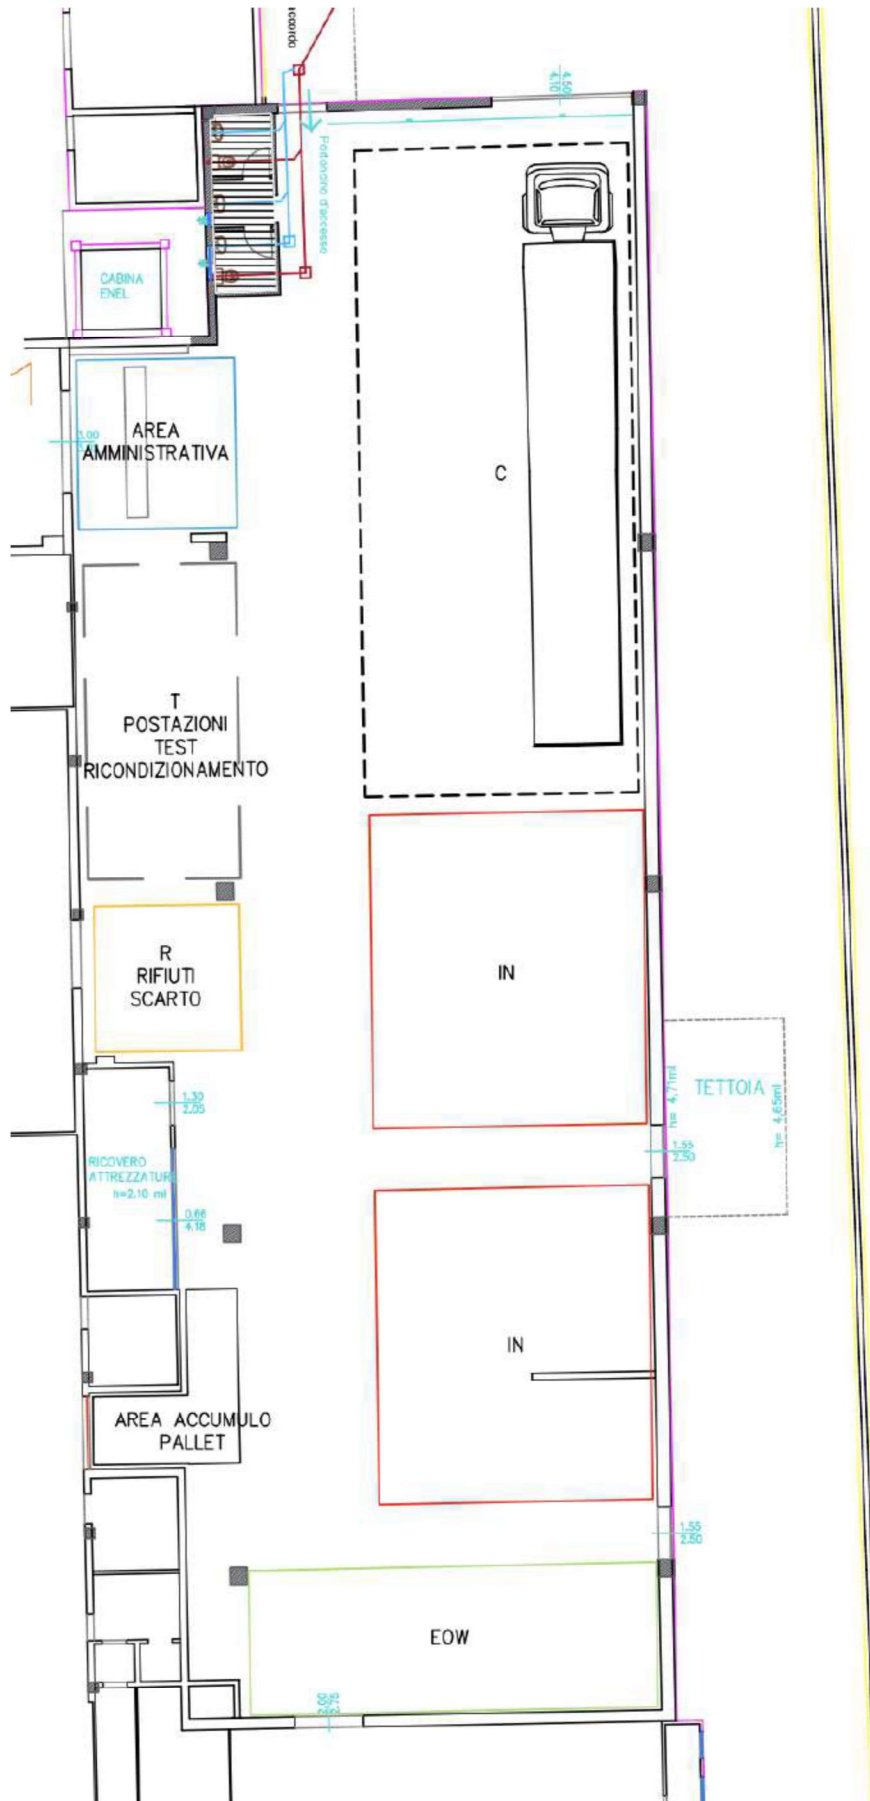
Estratto dell'elaborato grafico Tavola n. A3.8 "Planimetria Layout delle aree".
